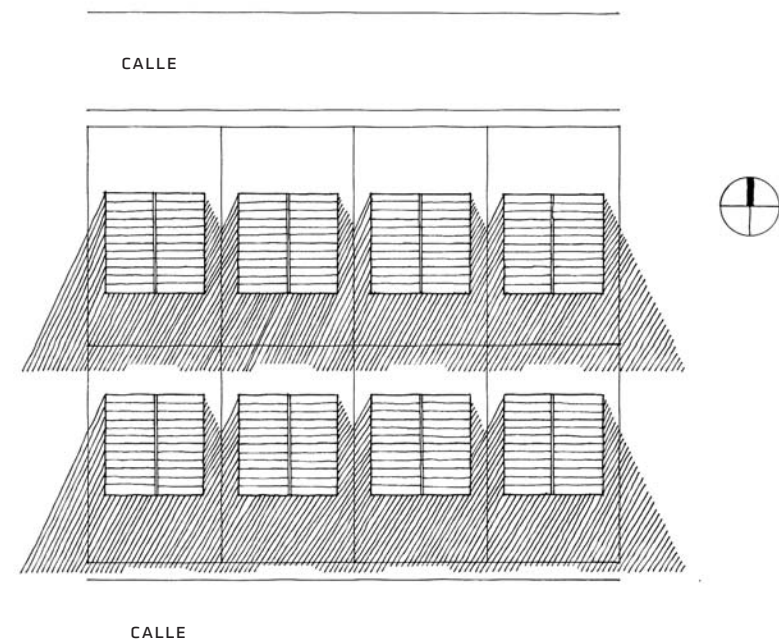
Calles en sentido oriente poniente permiten acceso solar en fachada norte.
